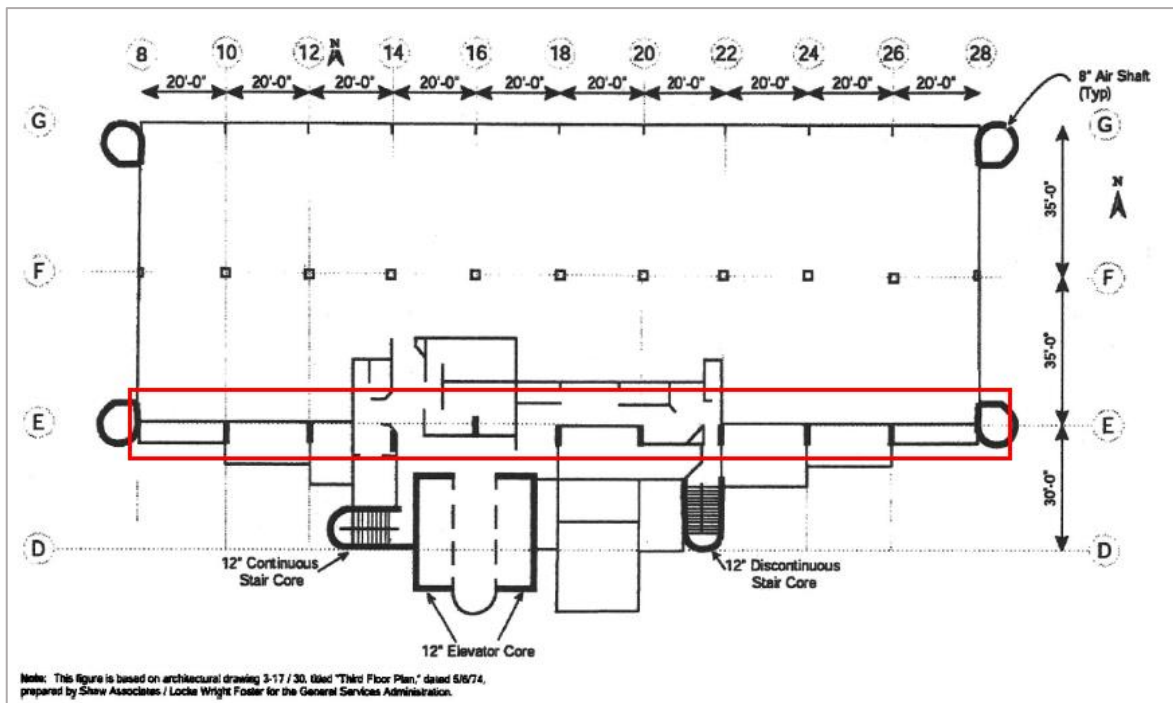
Plano de la tercera planta del Alfred P. Murrah. [26]
